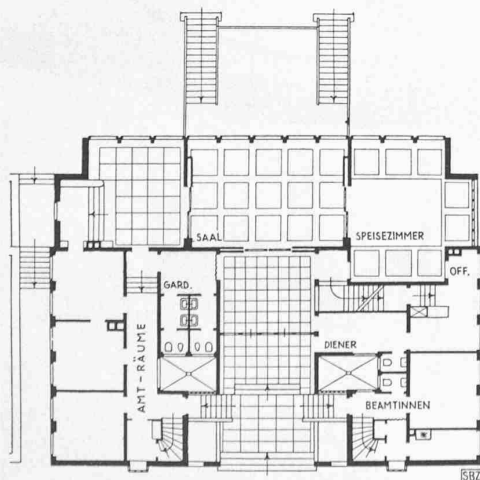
Erdgeschoss-Grundriss 1: 400
